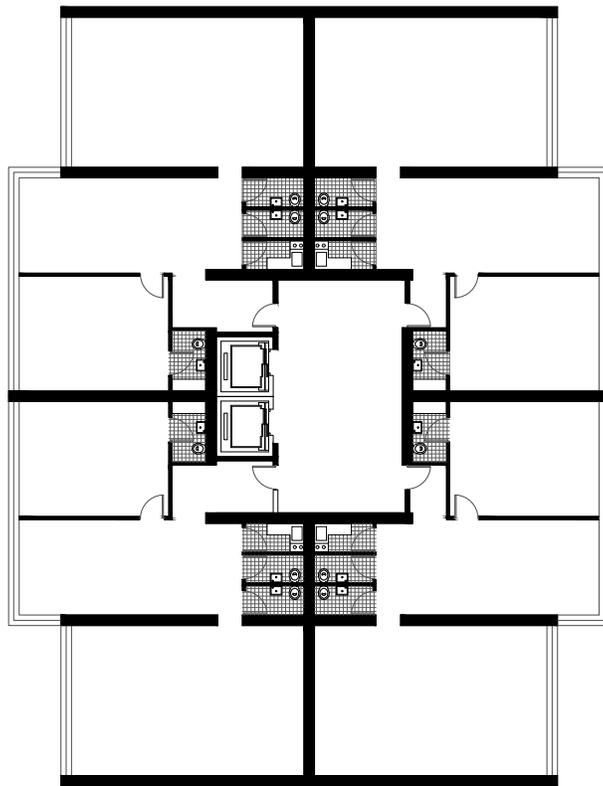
Planta 7º Nivel Edificio Terracota. Fuente: Elaboración Propia.
